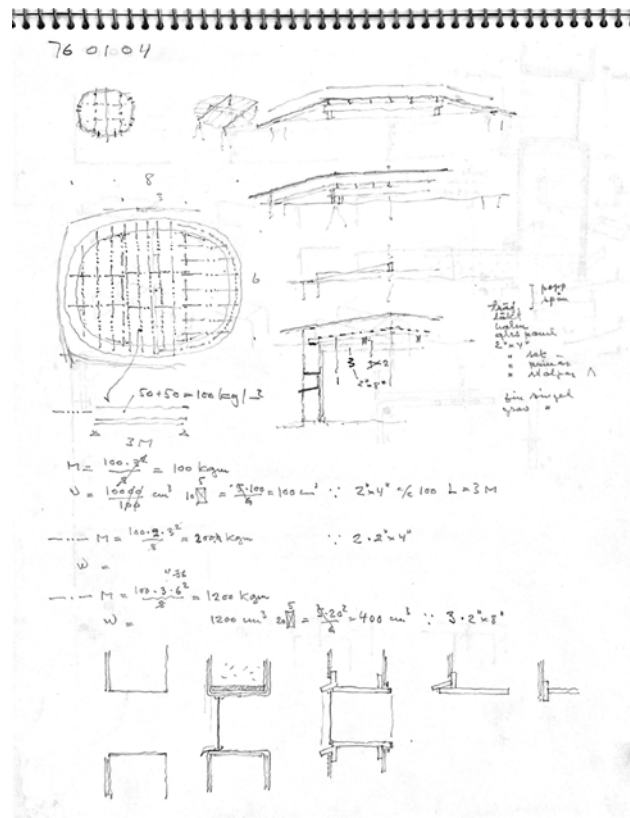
Detalles de embocaduras, dibujos y cálculos estructurales que tratan de resolver la cubierta de la casa de paja (Halmhus). Enero 1972. ArkDes
